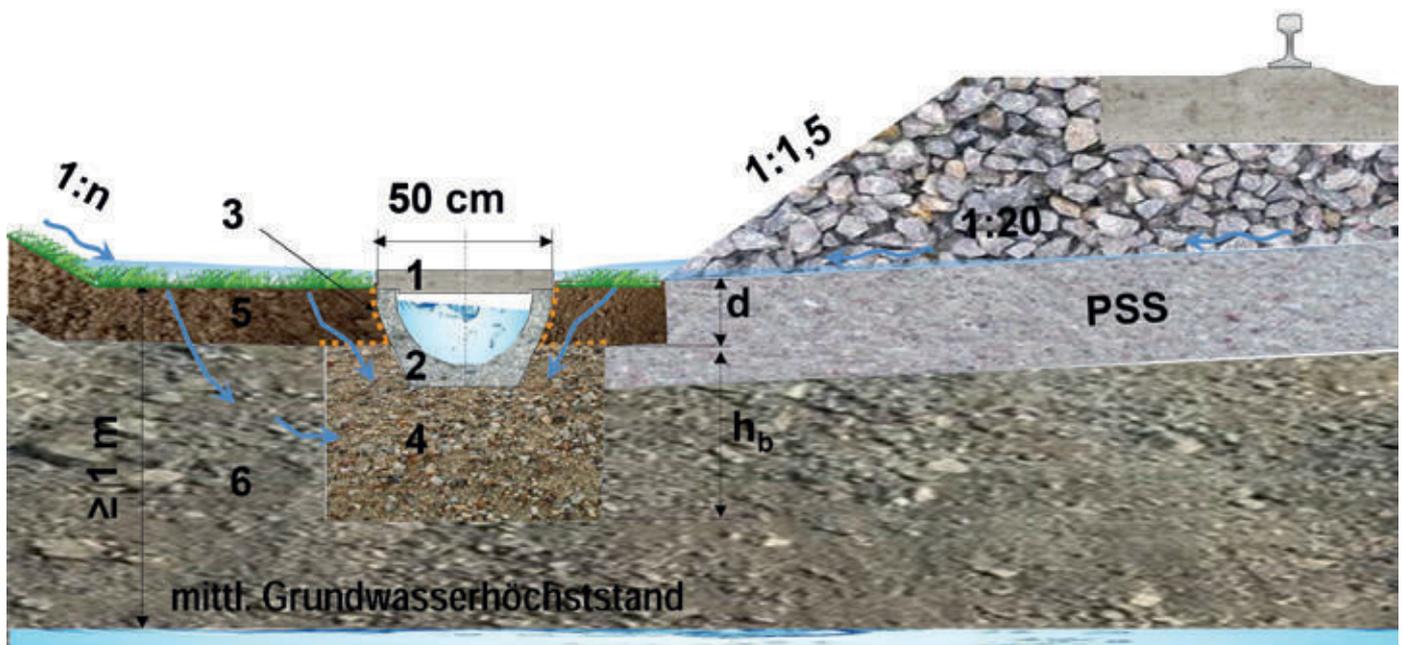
Entwässerung des Bahnkörpers und belebte Bodenschicht: (1) Abdeckplatte aus Beton (50/50 cm); (2) Haufwerksporige Betonhalbschale DN 400; (3) Filtervlies; (4) Bettung, Filtermaterial; (5) Belebte Bodenschicht, $d = 20$ bis 30 cm; (6) Anstehender Baugrund, $h_b \geq 50$ cm
